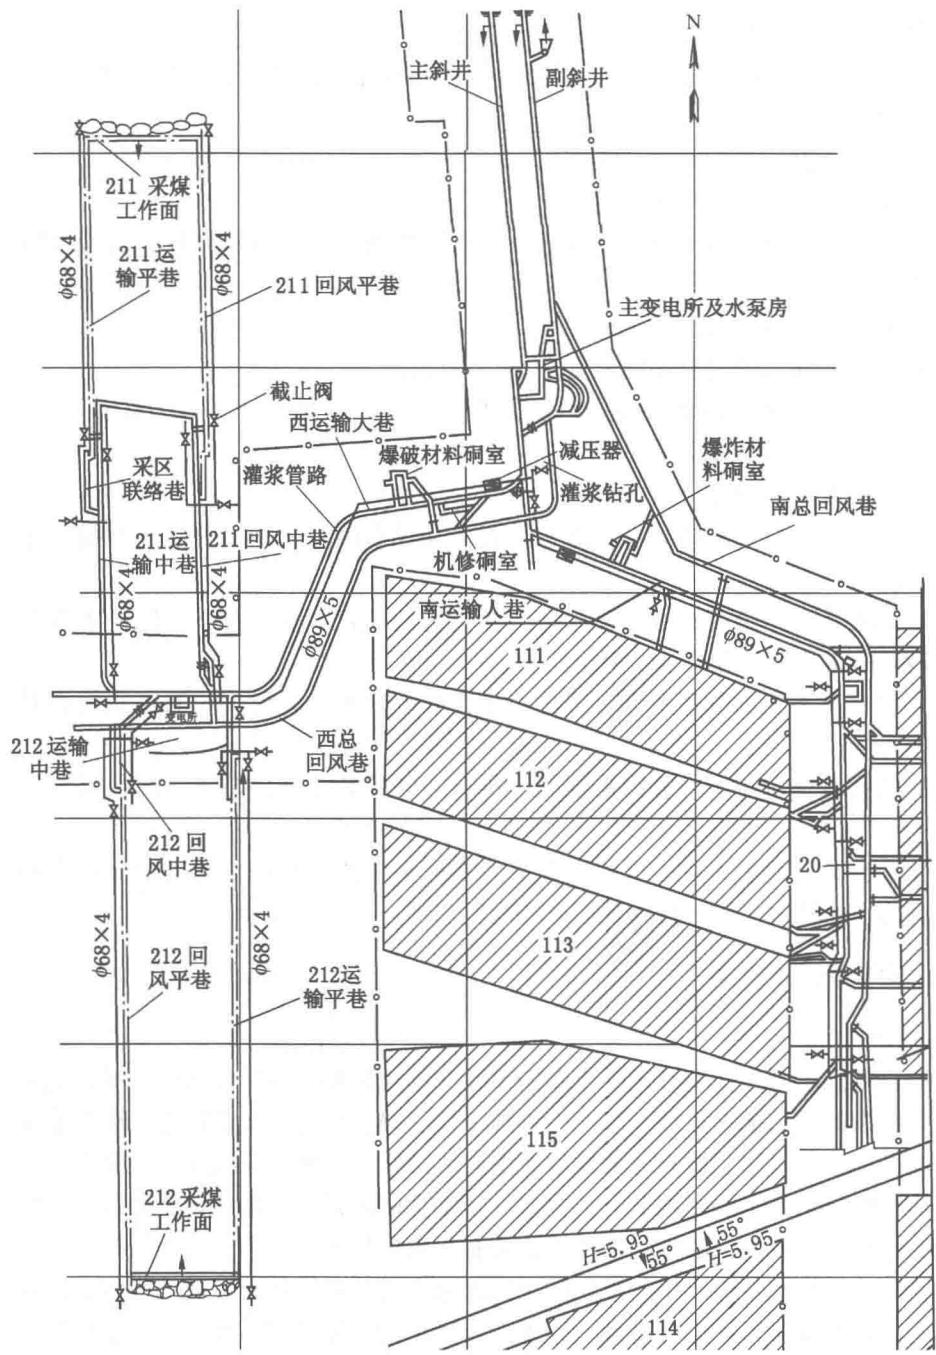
某矿井黄泥灌浆管路系统工程平面图
